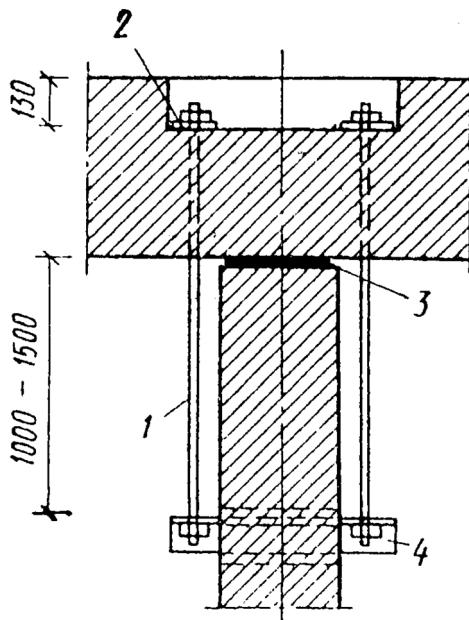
Усиление стальными тяжами пересечения кирпичных стен, ослабленного трещиной или швом
